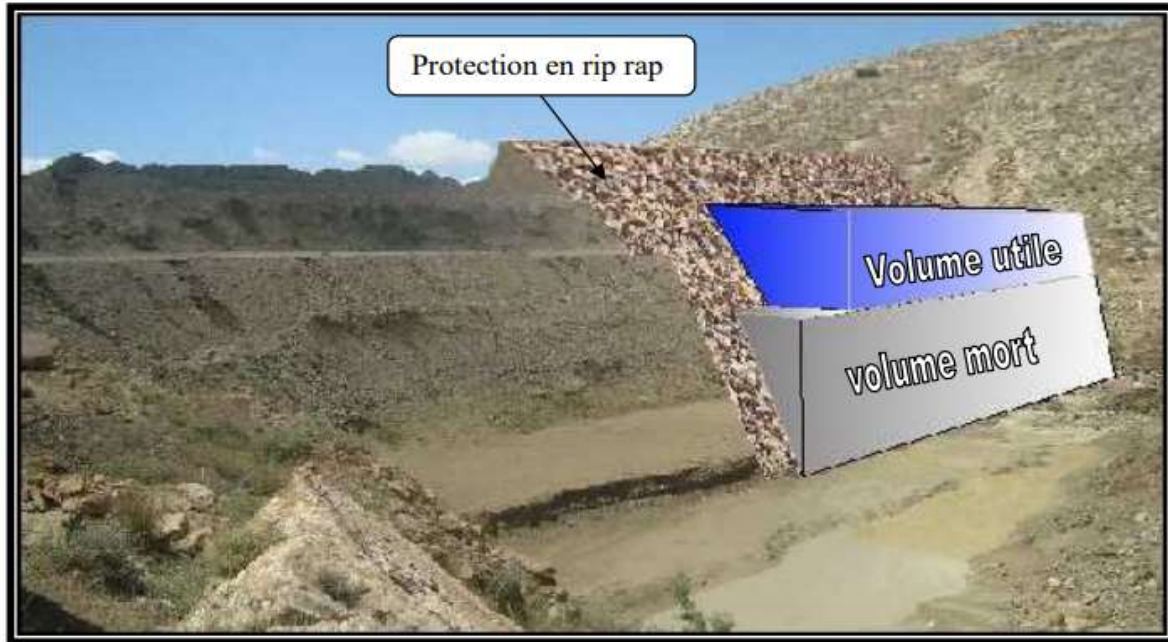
Photo imaginaire du barrage en fin de construction.
